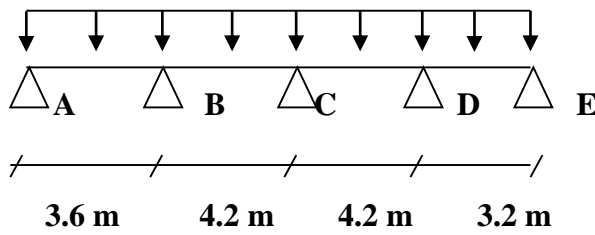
Schéma statique de la poutre reposant sur cinq appuis.
